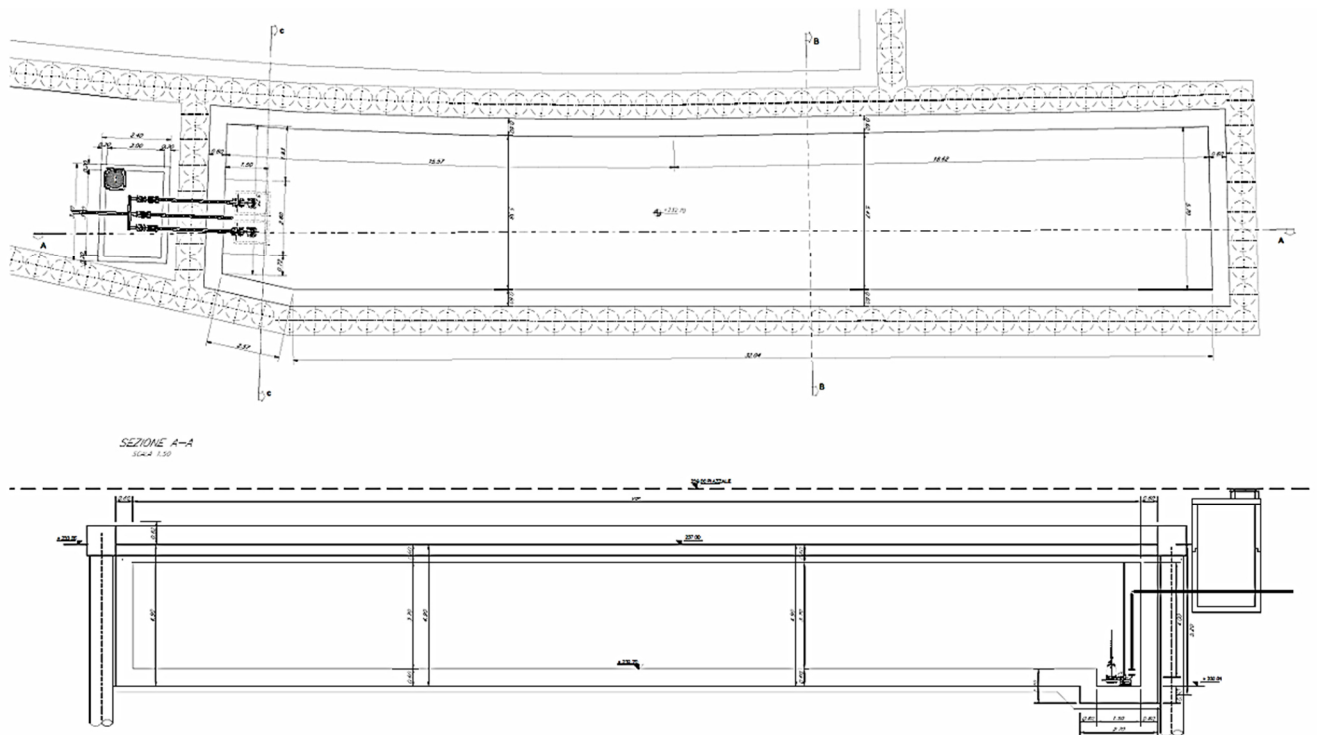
Vasca di laminazione acque di sede – pianta e sezione longitudinale
